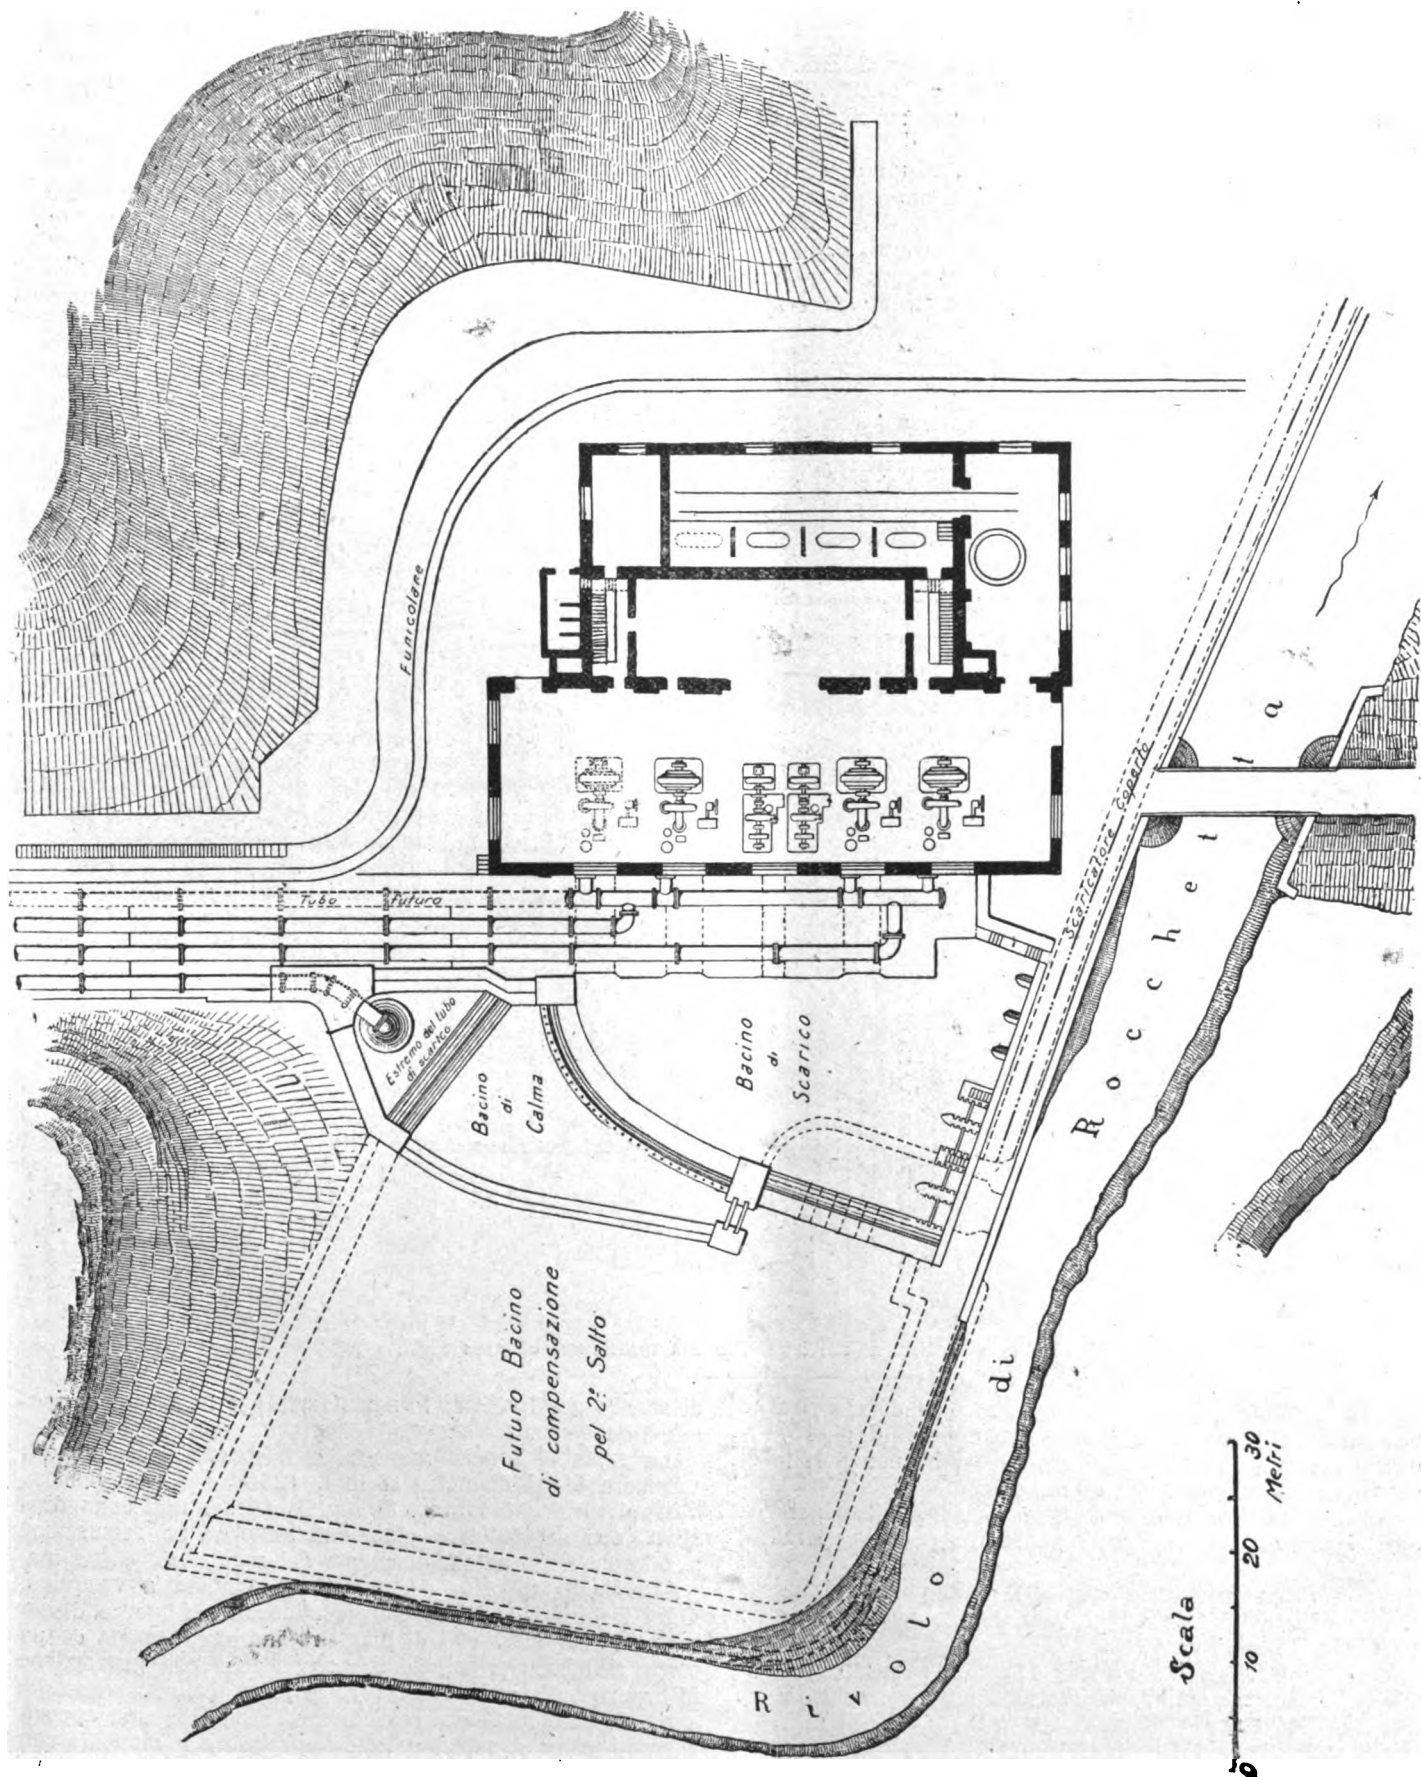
Planimetria della Centrale ed opere idrauliche annesse.
